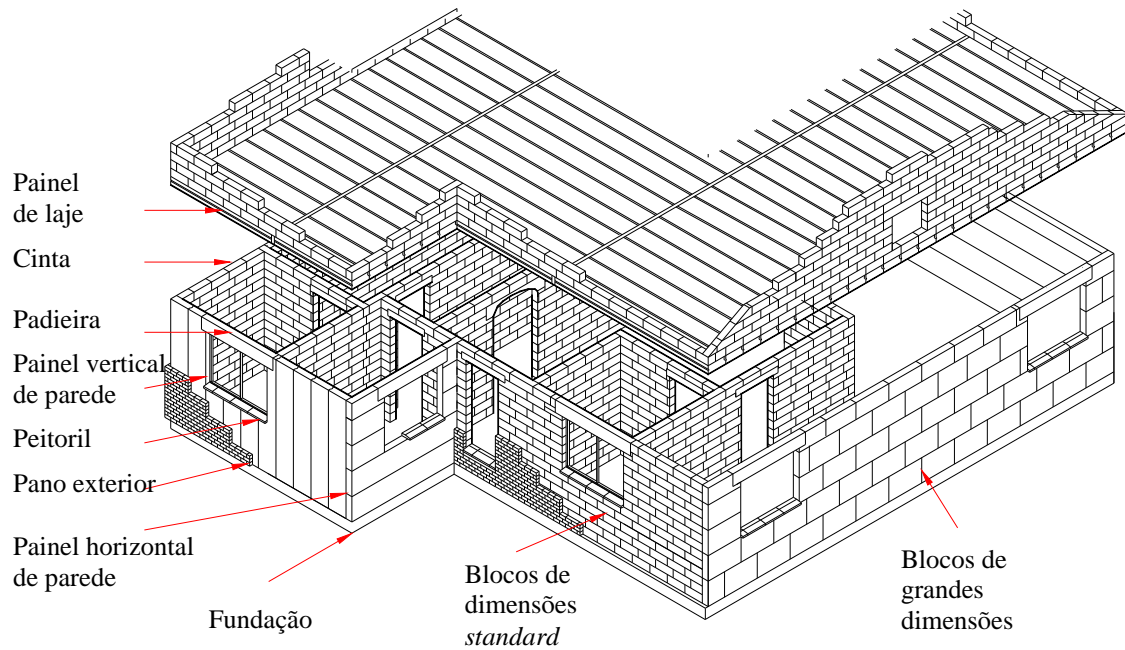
Componentes de sistema construtivo ACC (fonte: Babb International, Inc.)
